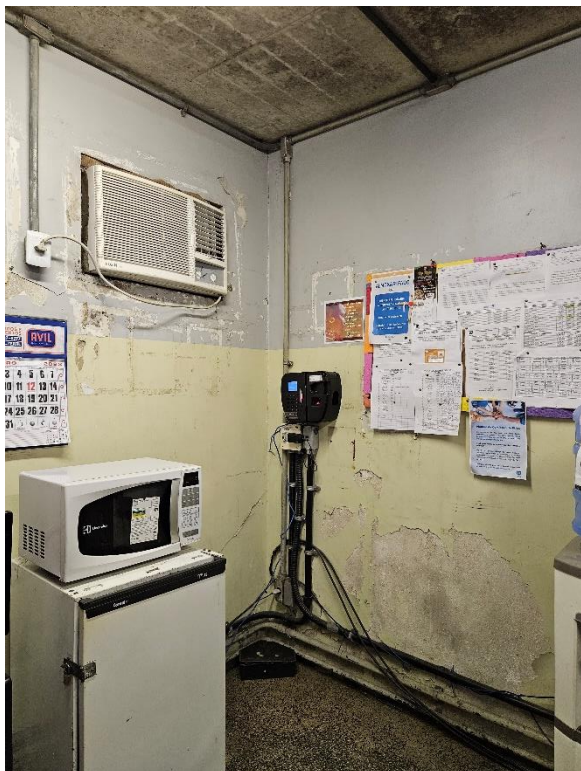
Salas Operacionais com infiltrações, ferragens expostas, improvisos em elétrica
